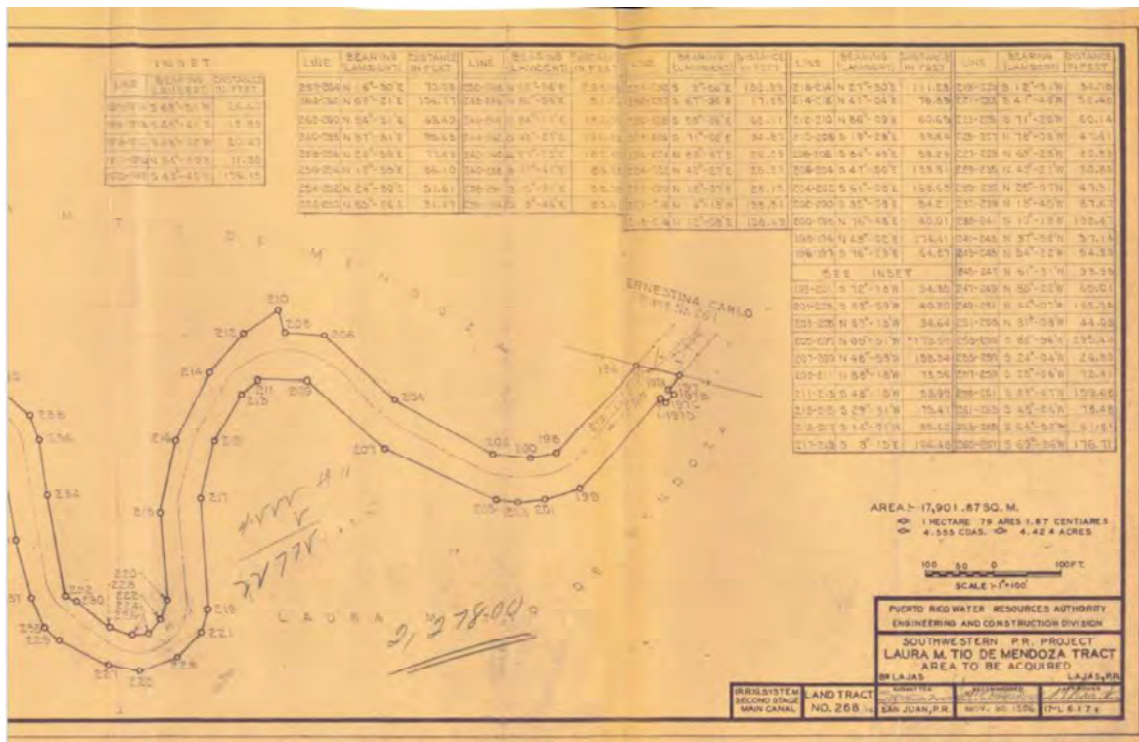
B: Continuación de Plano Escala: 1"=100' - Recomendado -Nov. 30-1956, Land Track No.268 – Puerto Rico Resources Authority Engineering and Construction División / Southwestern P.R., Project- Laura M. Tió de Mendoza-Track – Area to be Acquired, Bo. Lajas – Lajas, P.R.
